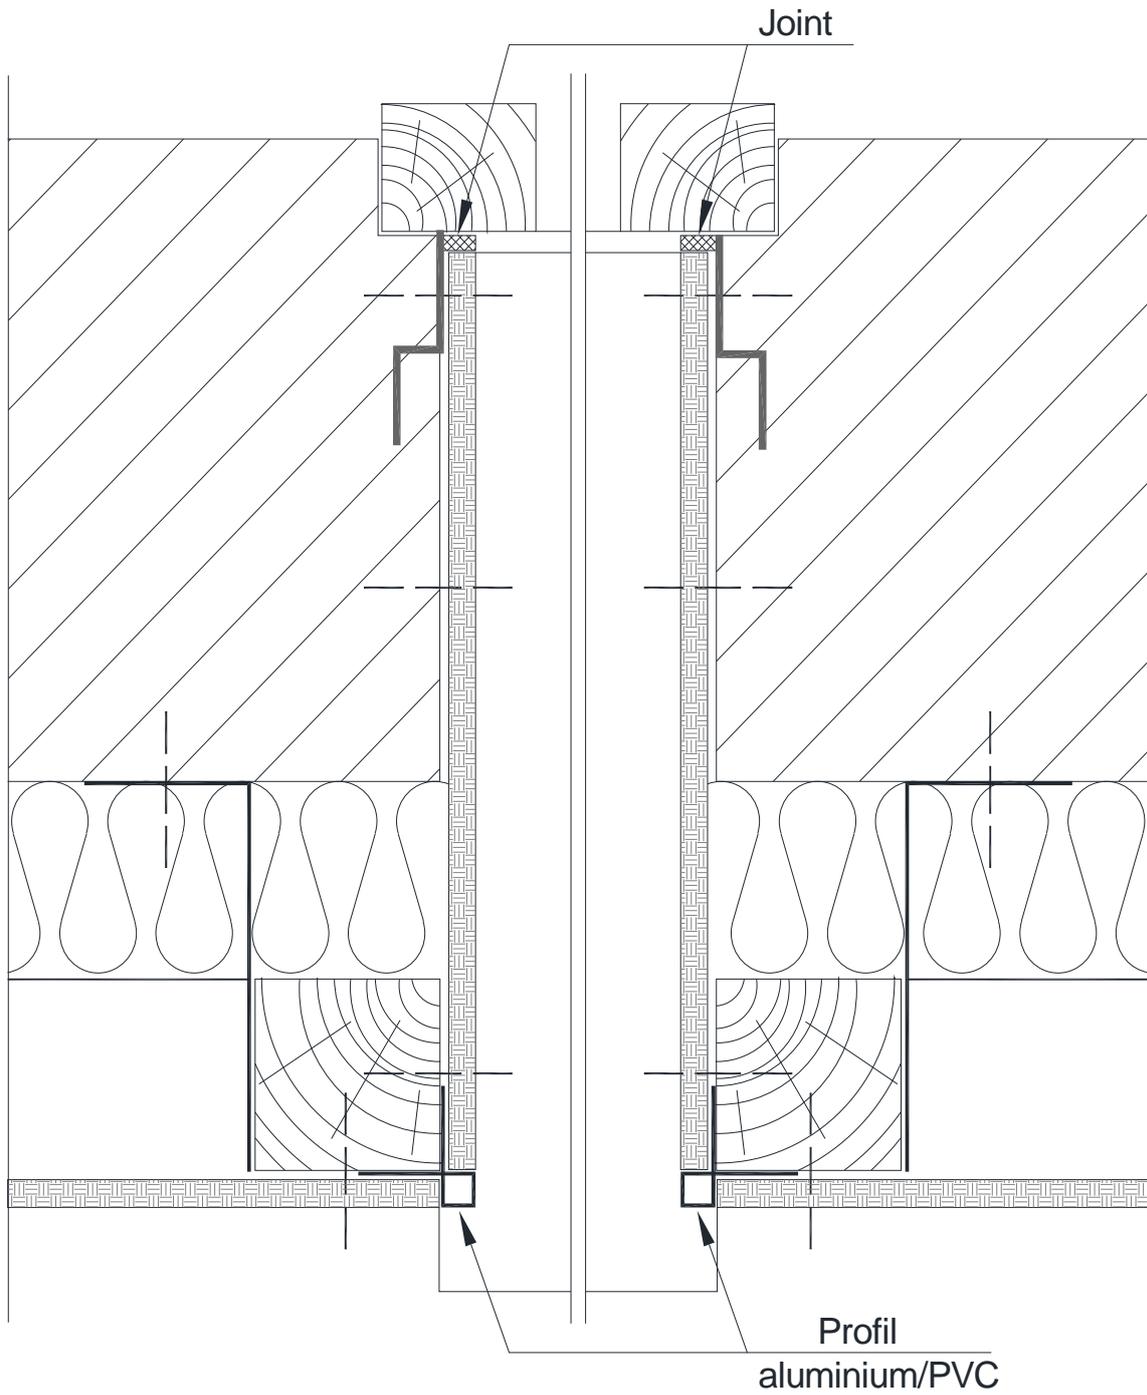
Encadrement de baie avec isolation complémentaire (Coupe verticale)
